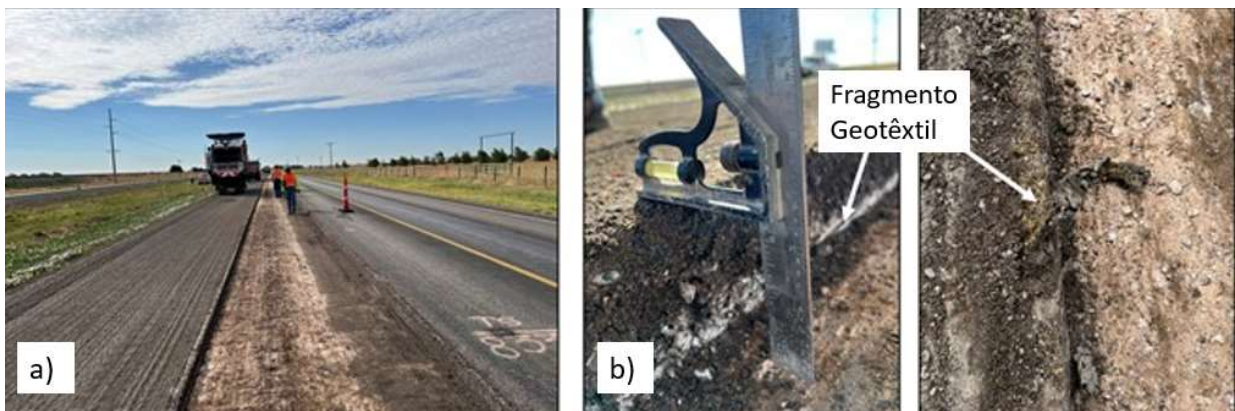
Etapas de fresagem para coleta do RAP e G-RAP: (a) fresagem no campo b) espessura de fresagem e detalhe do geotêxtil. Fonte: Adaptado de Saxena et al. (2023).
